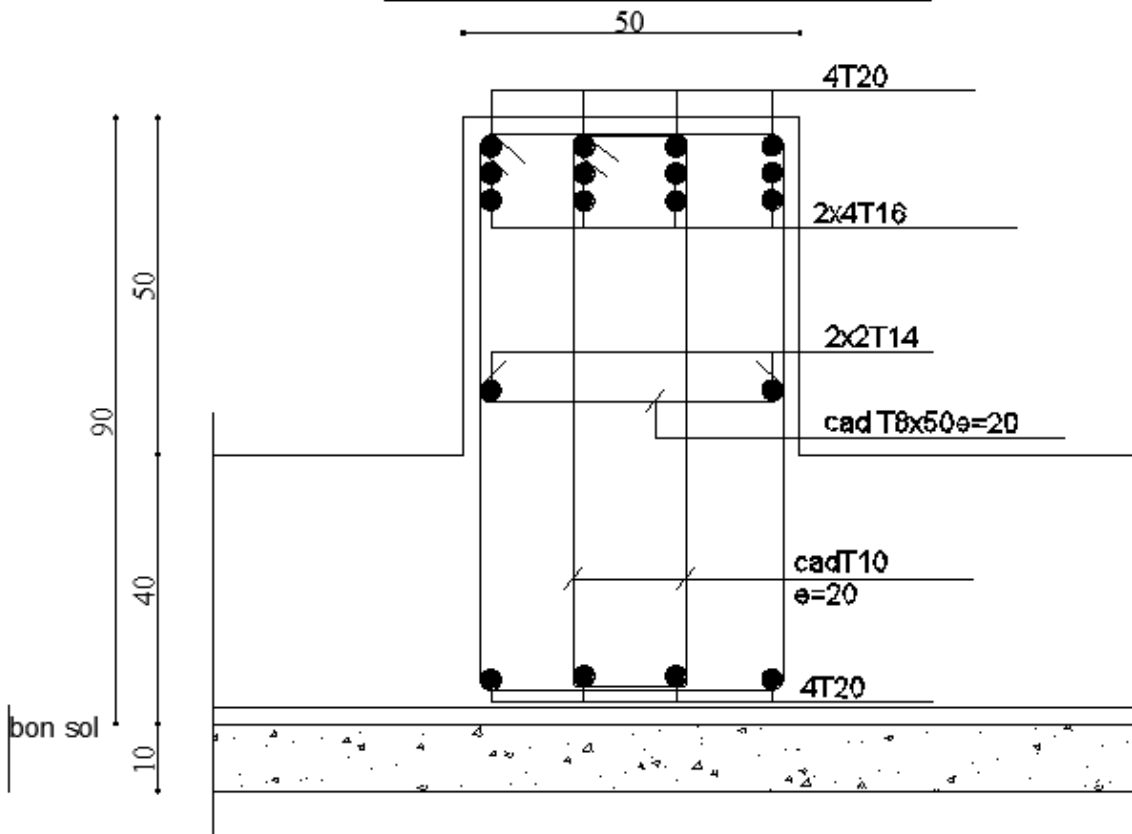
schéma de ferrailage de la poutre secondaire
